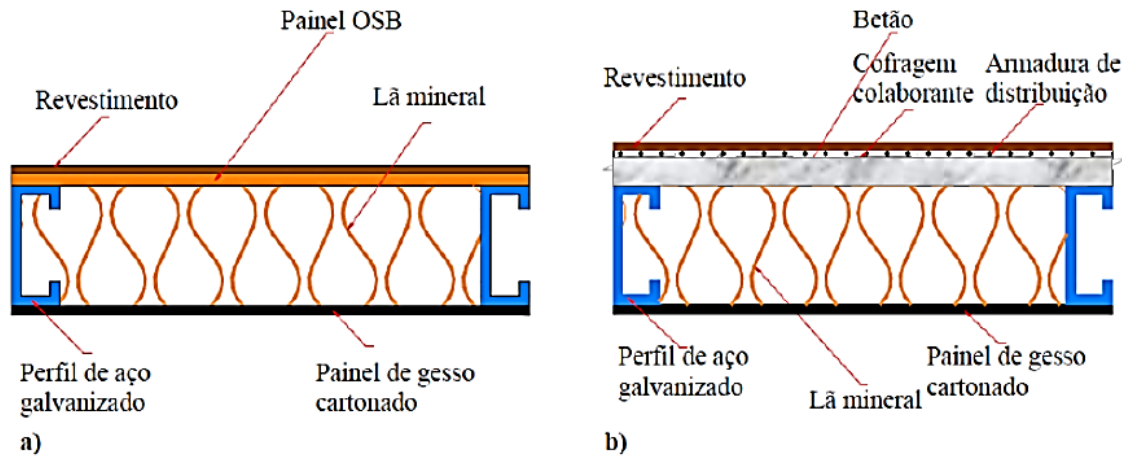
Lajes tipo: a) laje seca; b) laje húmida.
